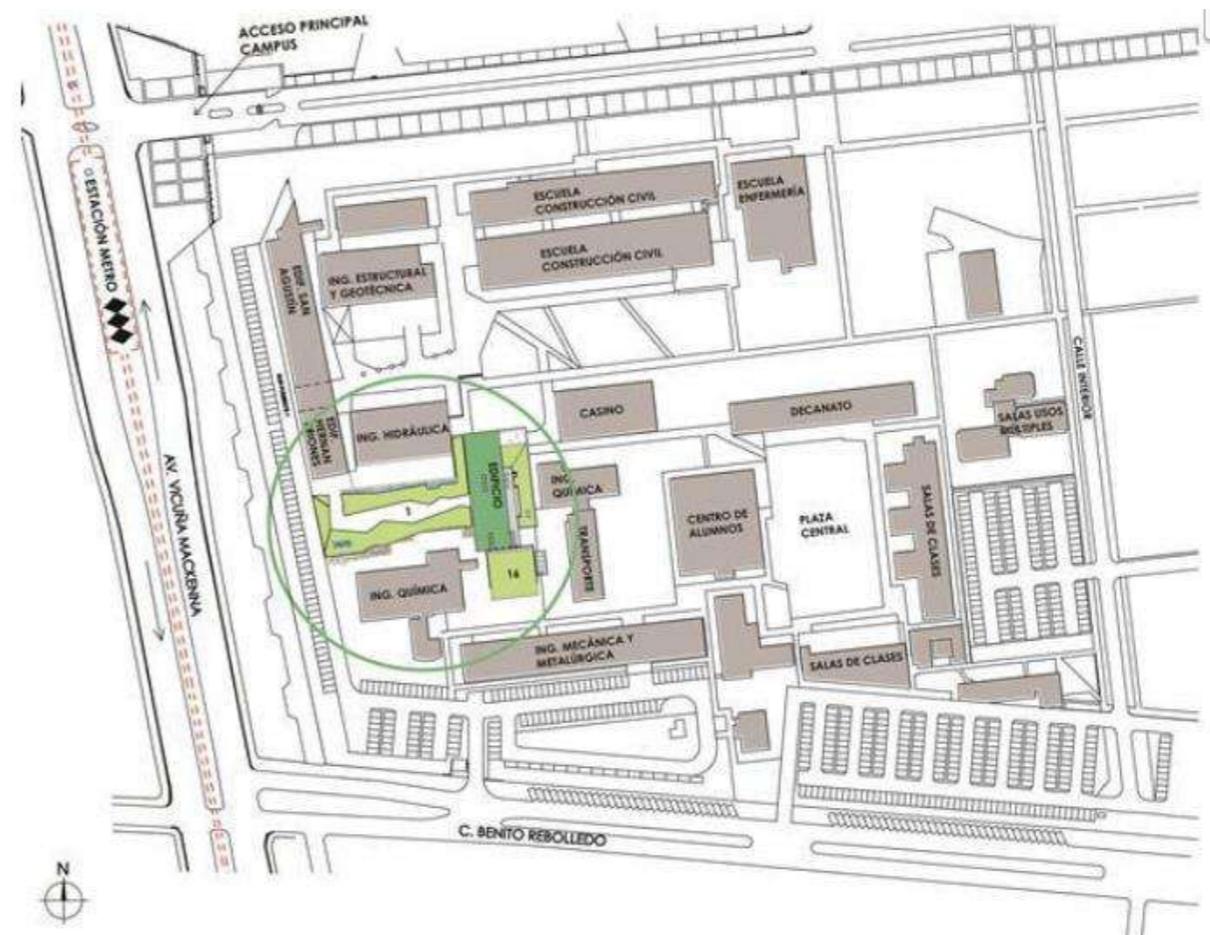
Planta de Conjunto del Centro de Minería. Fuente:
